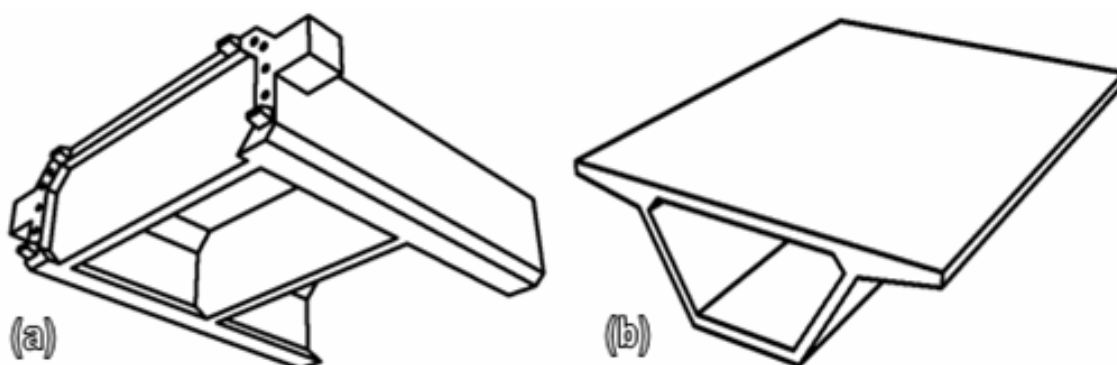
(a) Perfil aberto para a aduela. (b) Perfil utilizado em estruturas de ponte.
